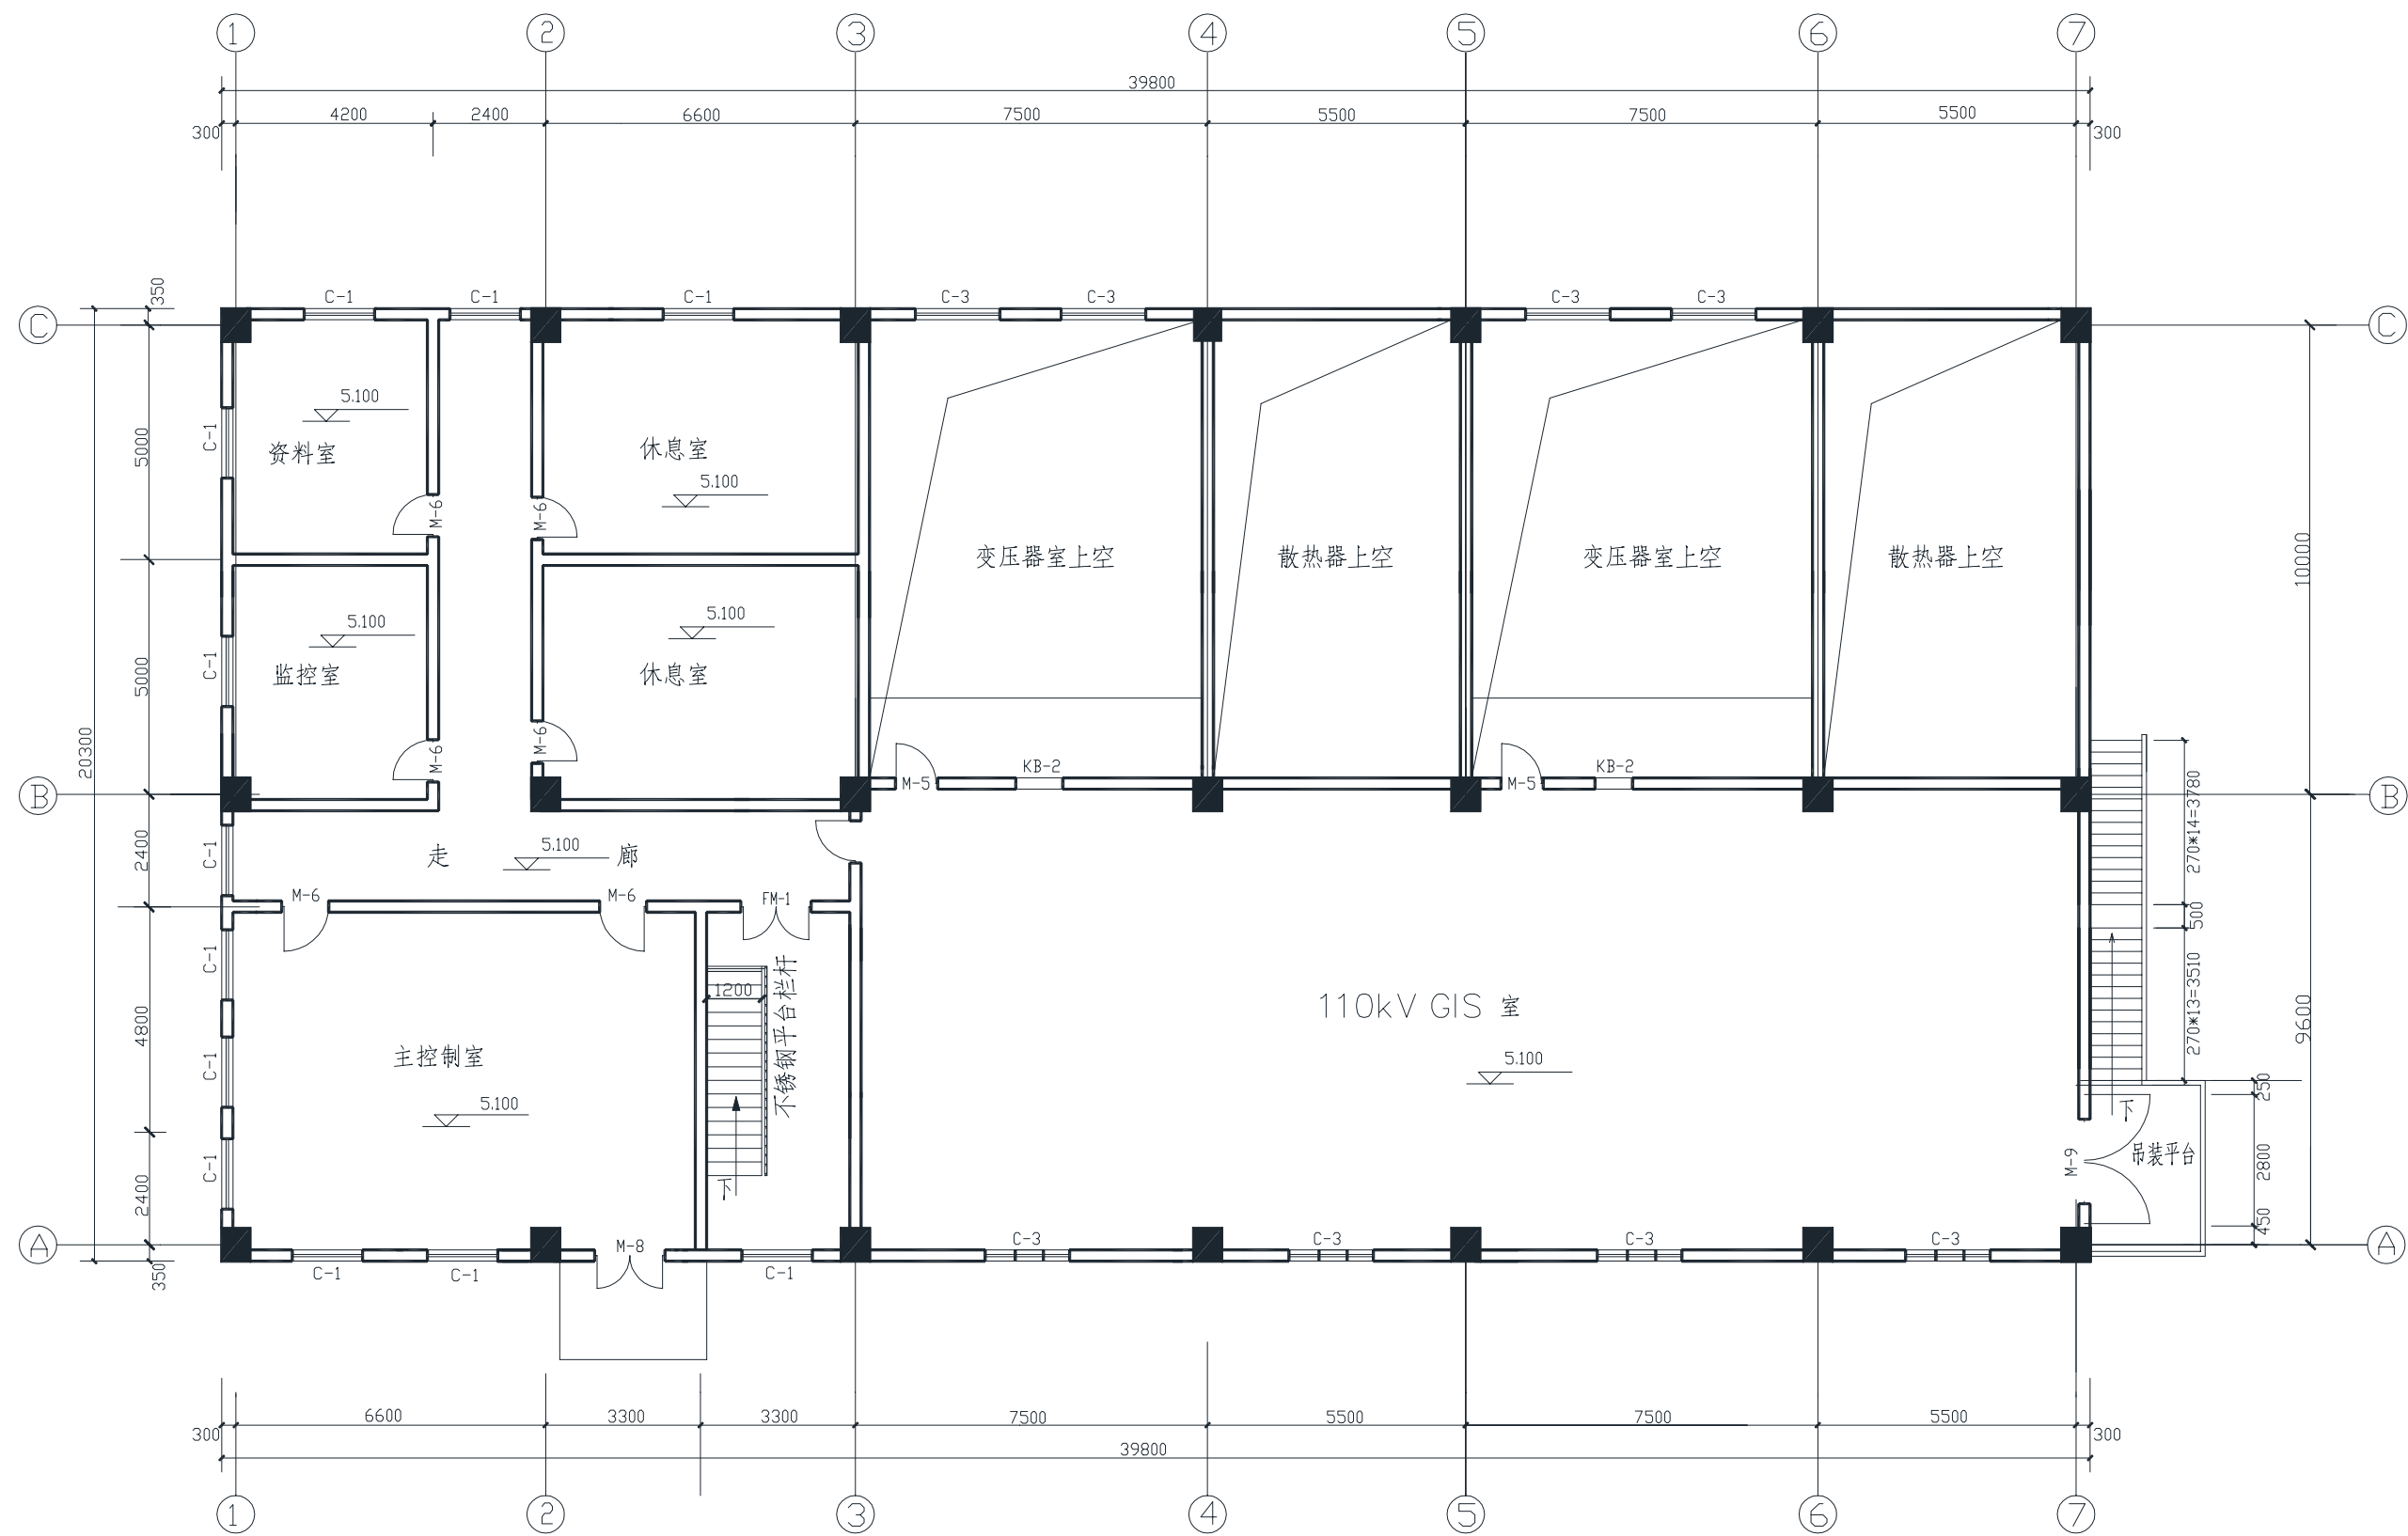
综合配电楼二层平面布置图 (A2-1-07)
